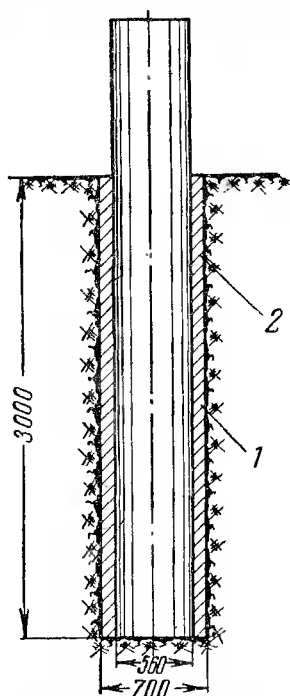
Нижняя часть железобетонной опоры без ригелей.
